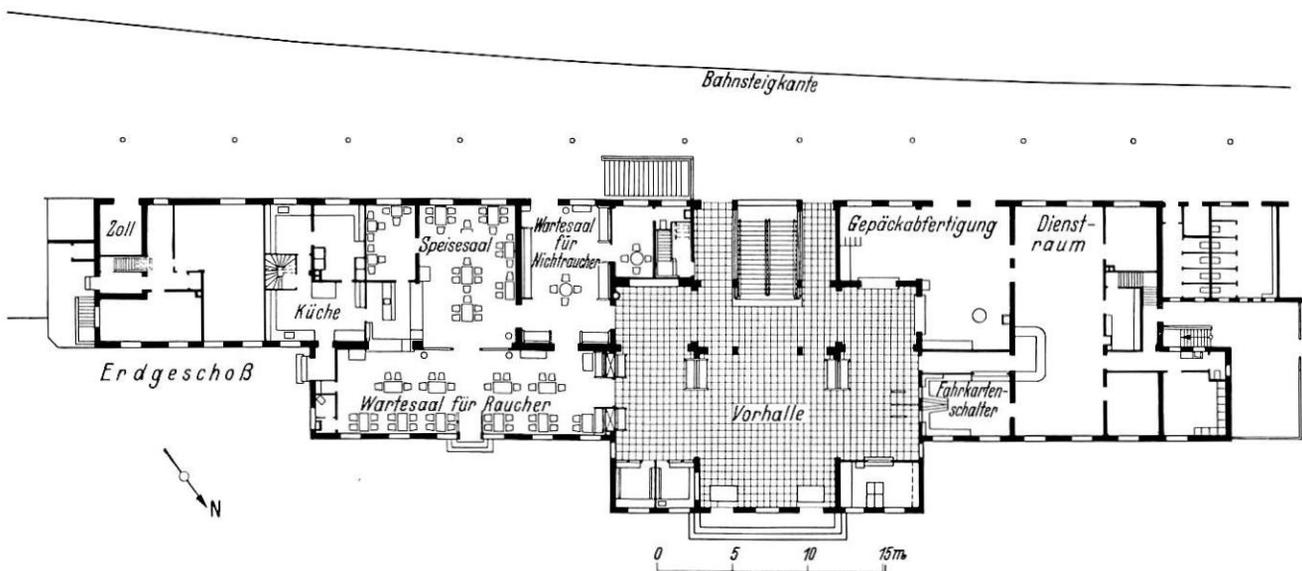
Empfangsgebäude Randers nach dem Umbau.
